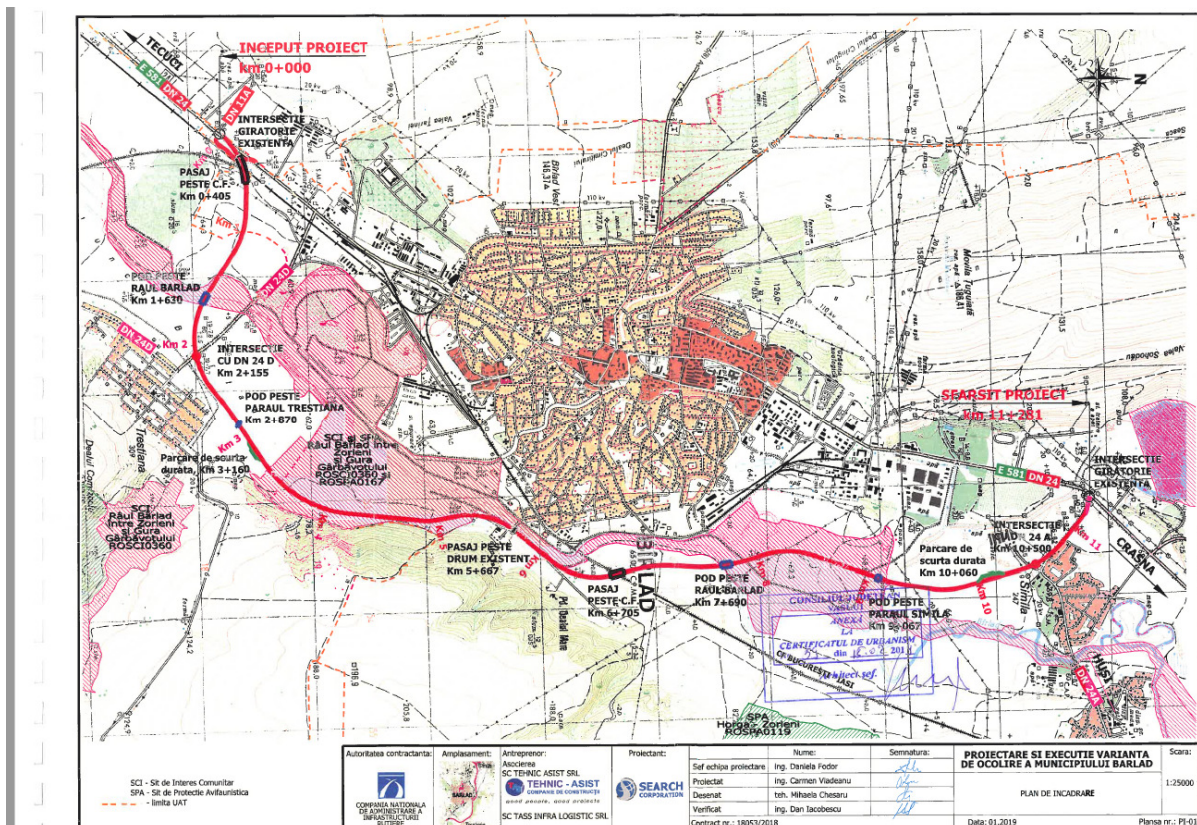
Plan de încadrare Varianta ocolitoare Barlad
